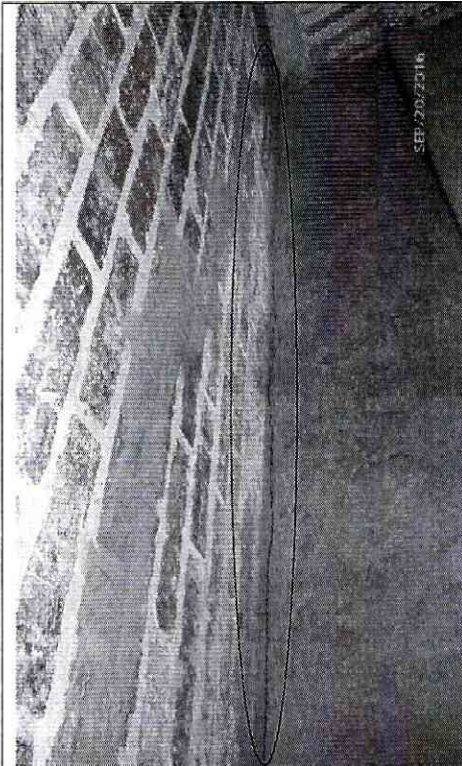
Sector sur del predio localizado en la Calle 82A Sur No 18M – 17.
